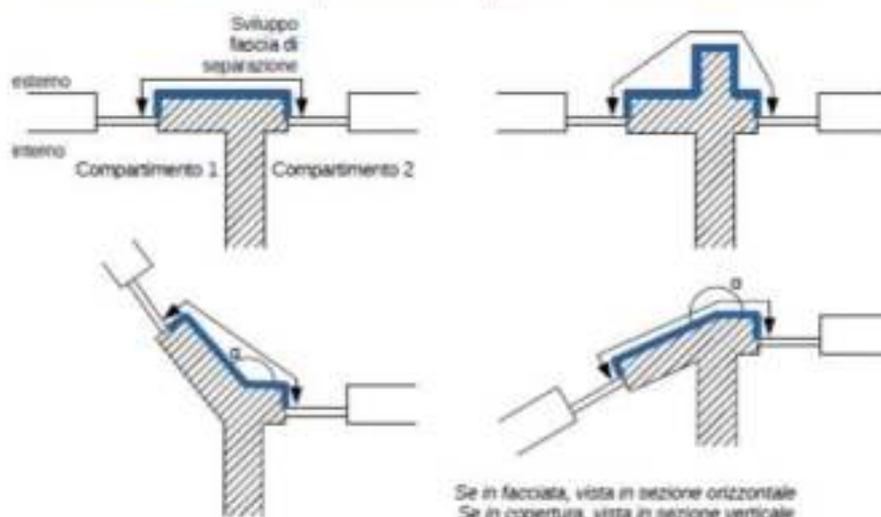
Esempi di fascia di separazione verticale in facciata o in copertura
